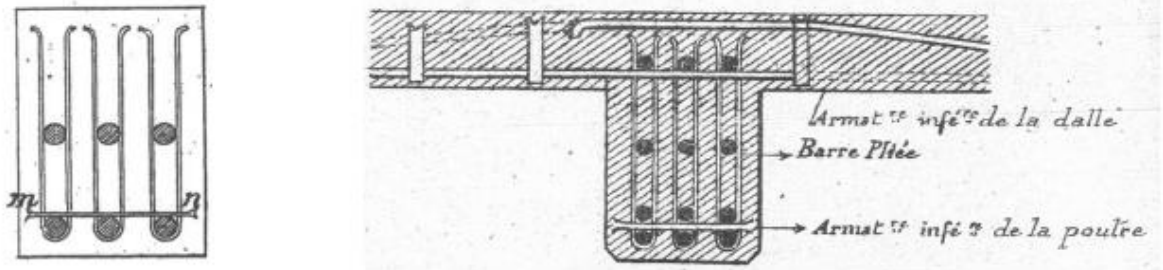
Armadura transversal junto à face inferior da viga (Appleton, 2013)
